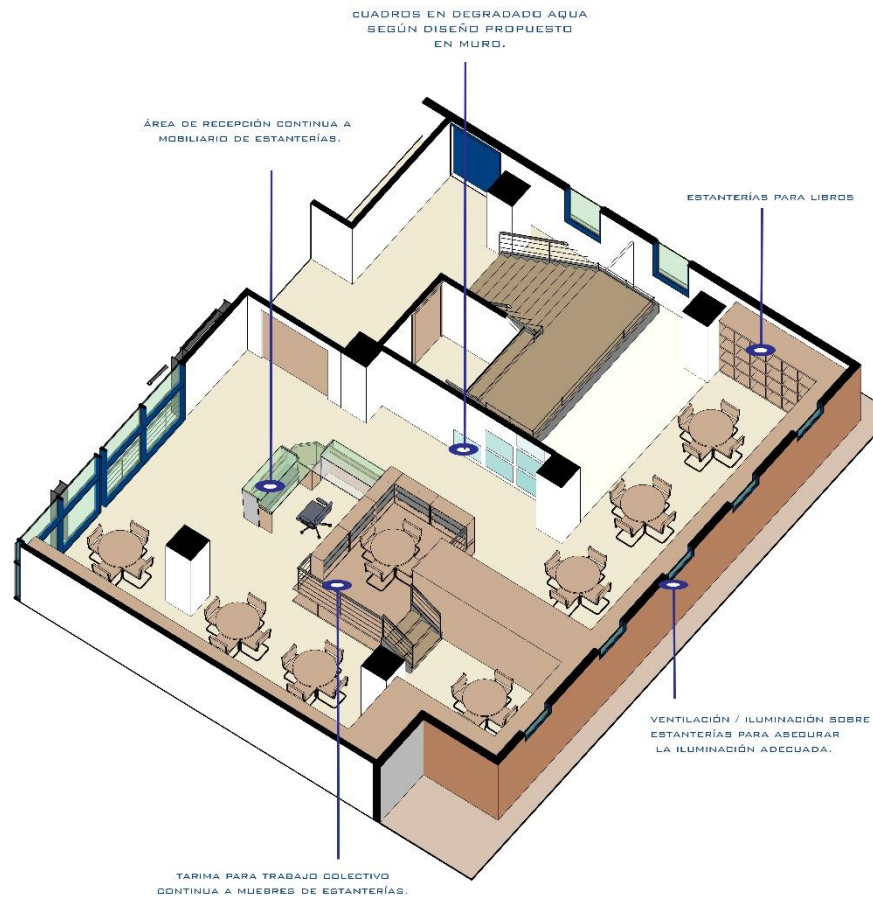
Detalle 1 Biblioteca. Fuente: Elaboración propia.
